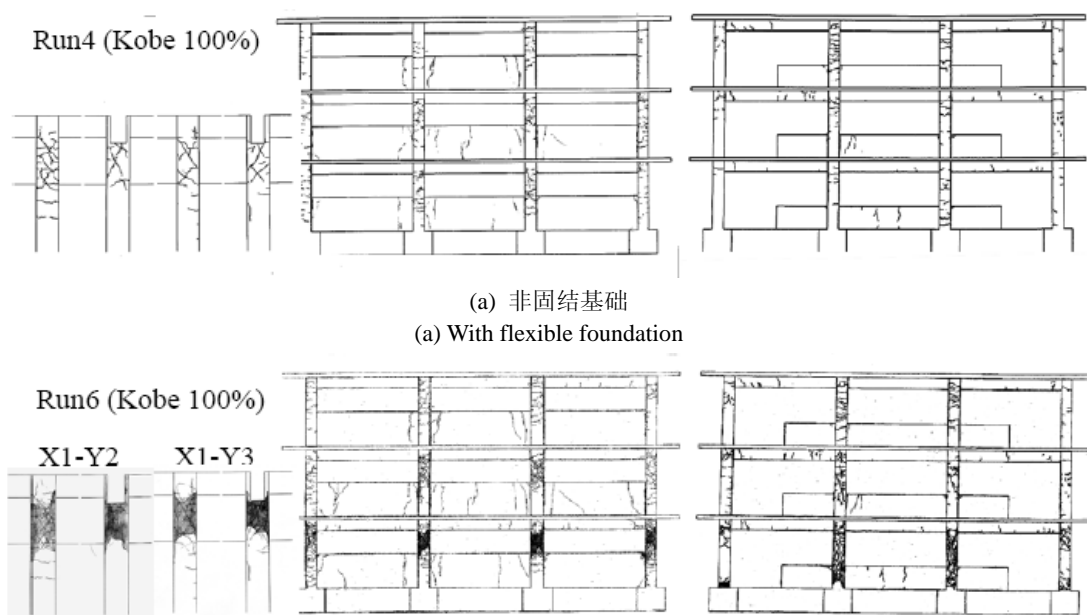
非固结基础上钢筋混凝土教学教足尺模型的 E-Defense 振动台试验立面示意图
